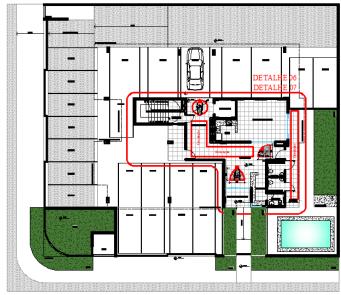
Planta Baixa - Pavimento térreo (3)
